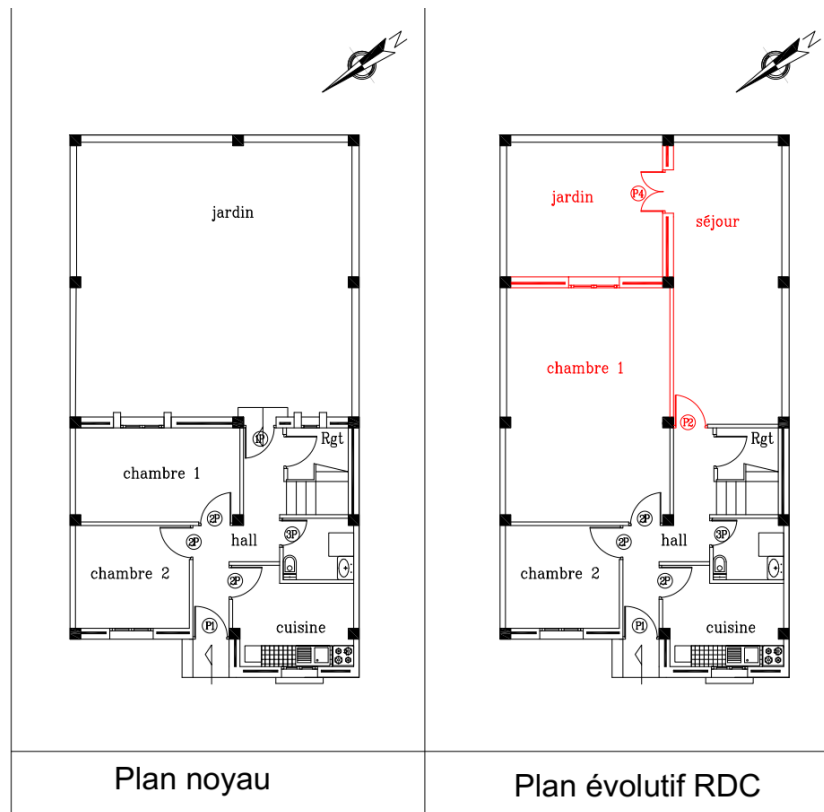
Plans proposés de la maison n°221 (Source : Auteur, 2022)
